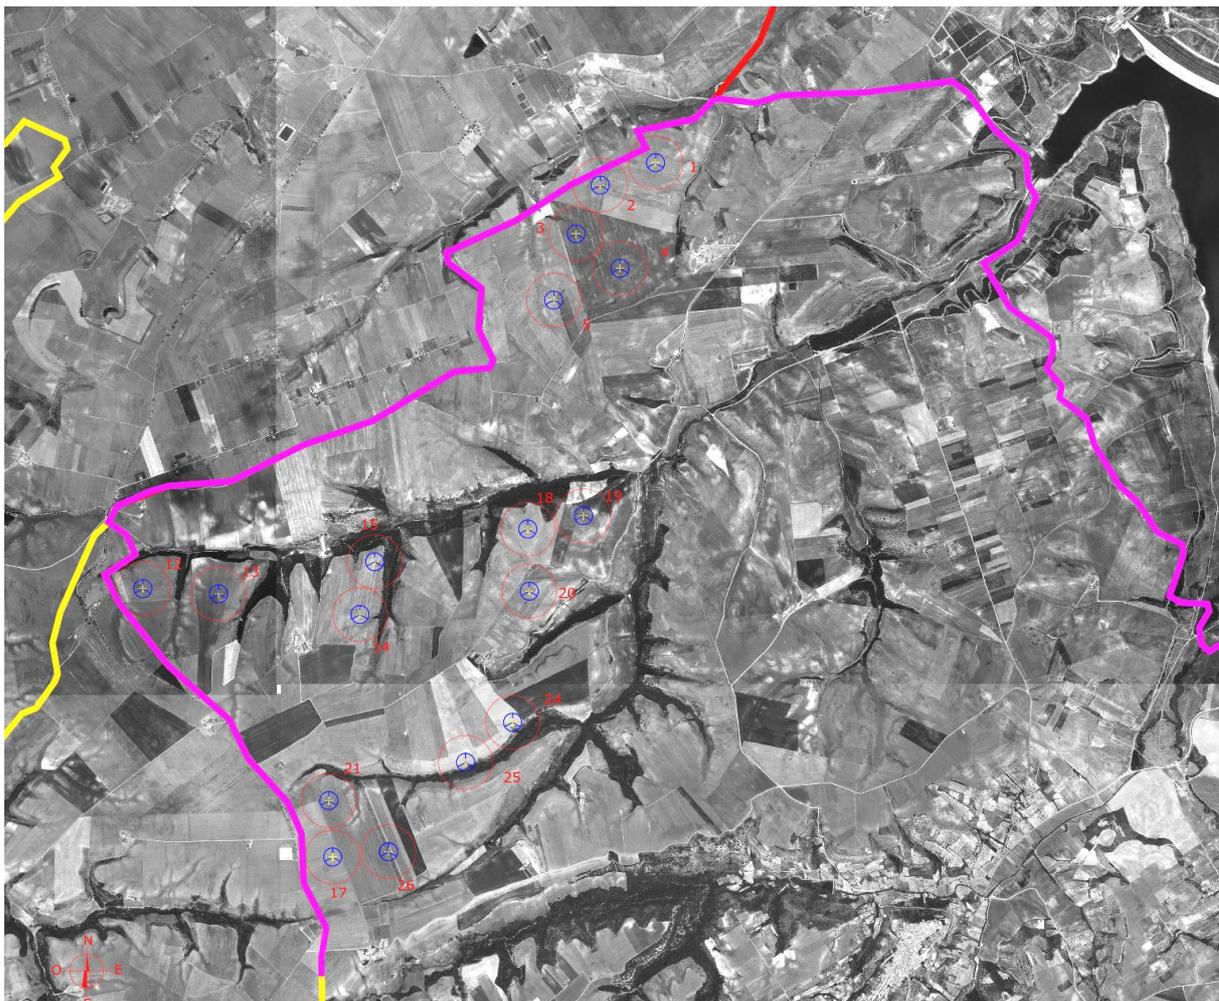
Planimetria su ortofoto del Parco Eolico Montemilone e opere connesse
